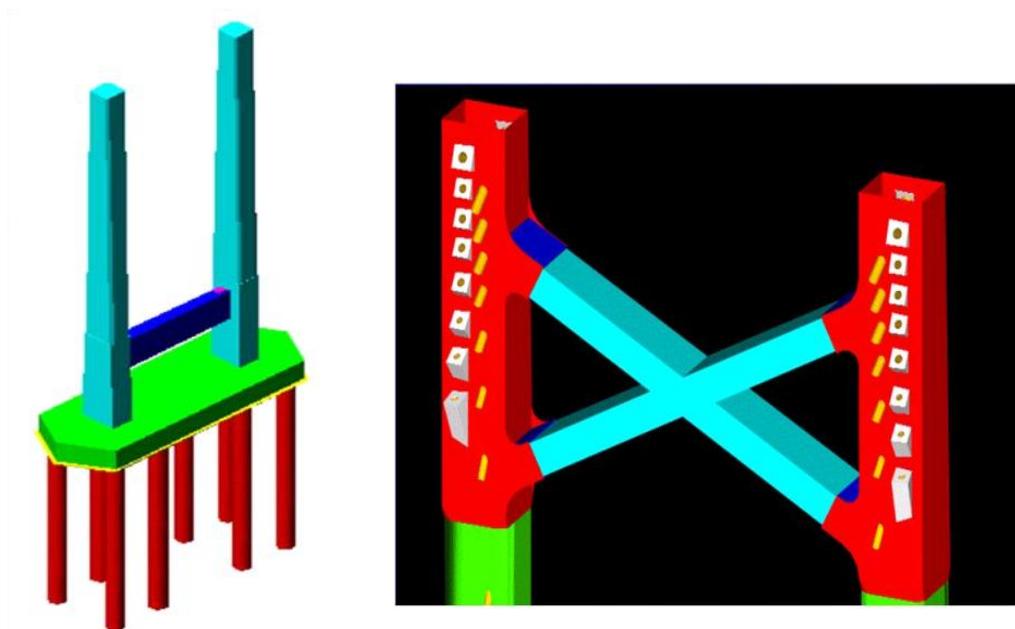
Detalle de los pilones, pilotes, cáscara y cruz metálica.
